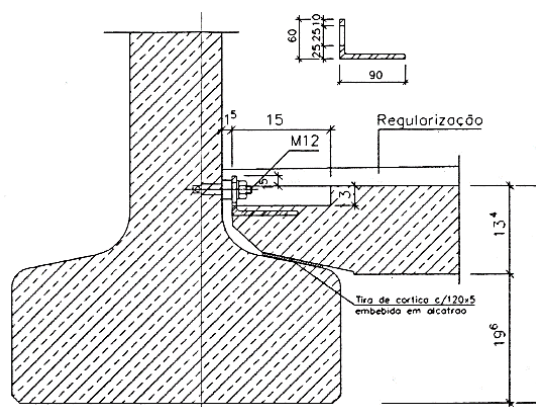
Esquema da secção transversal com pormenor das ligações Laje-Viga (Memória Descritiva, 2000)
